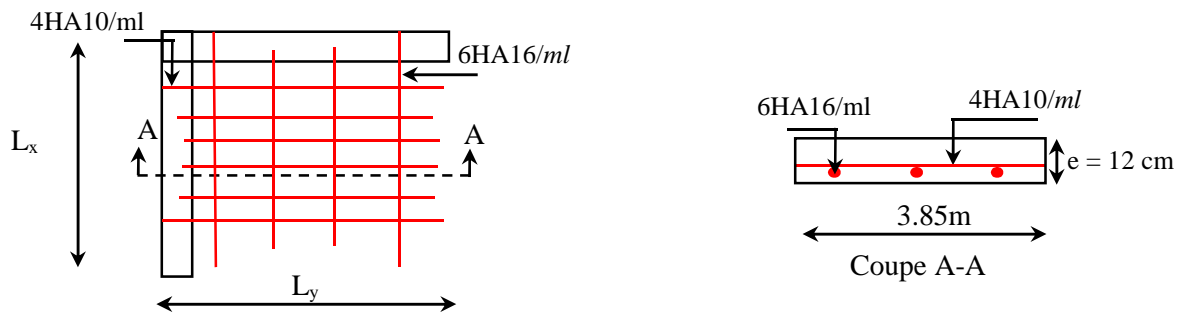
Schéma de ferrailage de la dalle D2'.
